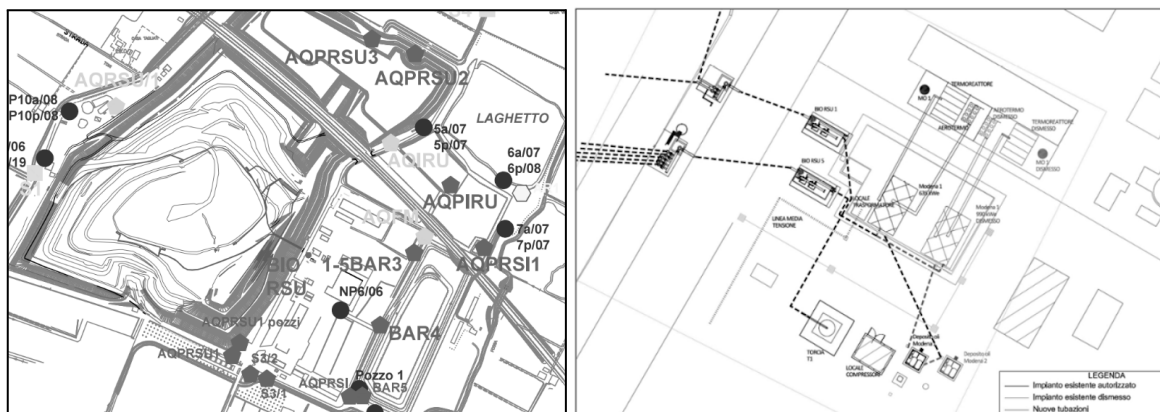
Planimetria Area 3 via Caruso: rete di monitoraggio (a sinistra) e particolare rete di captazione e combustione biogas (a destra)
